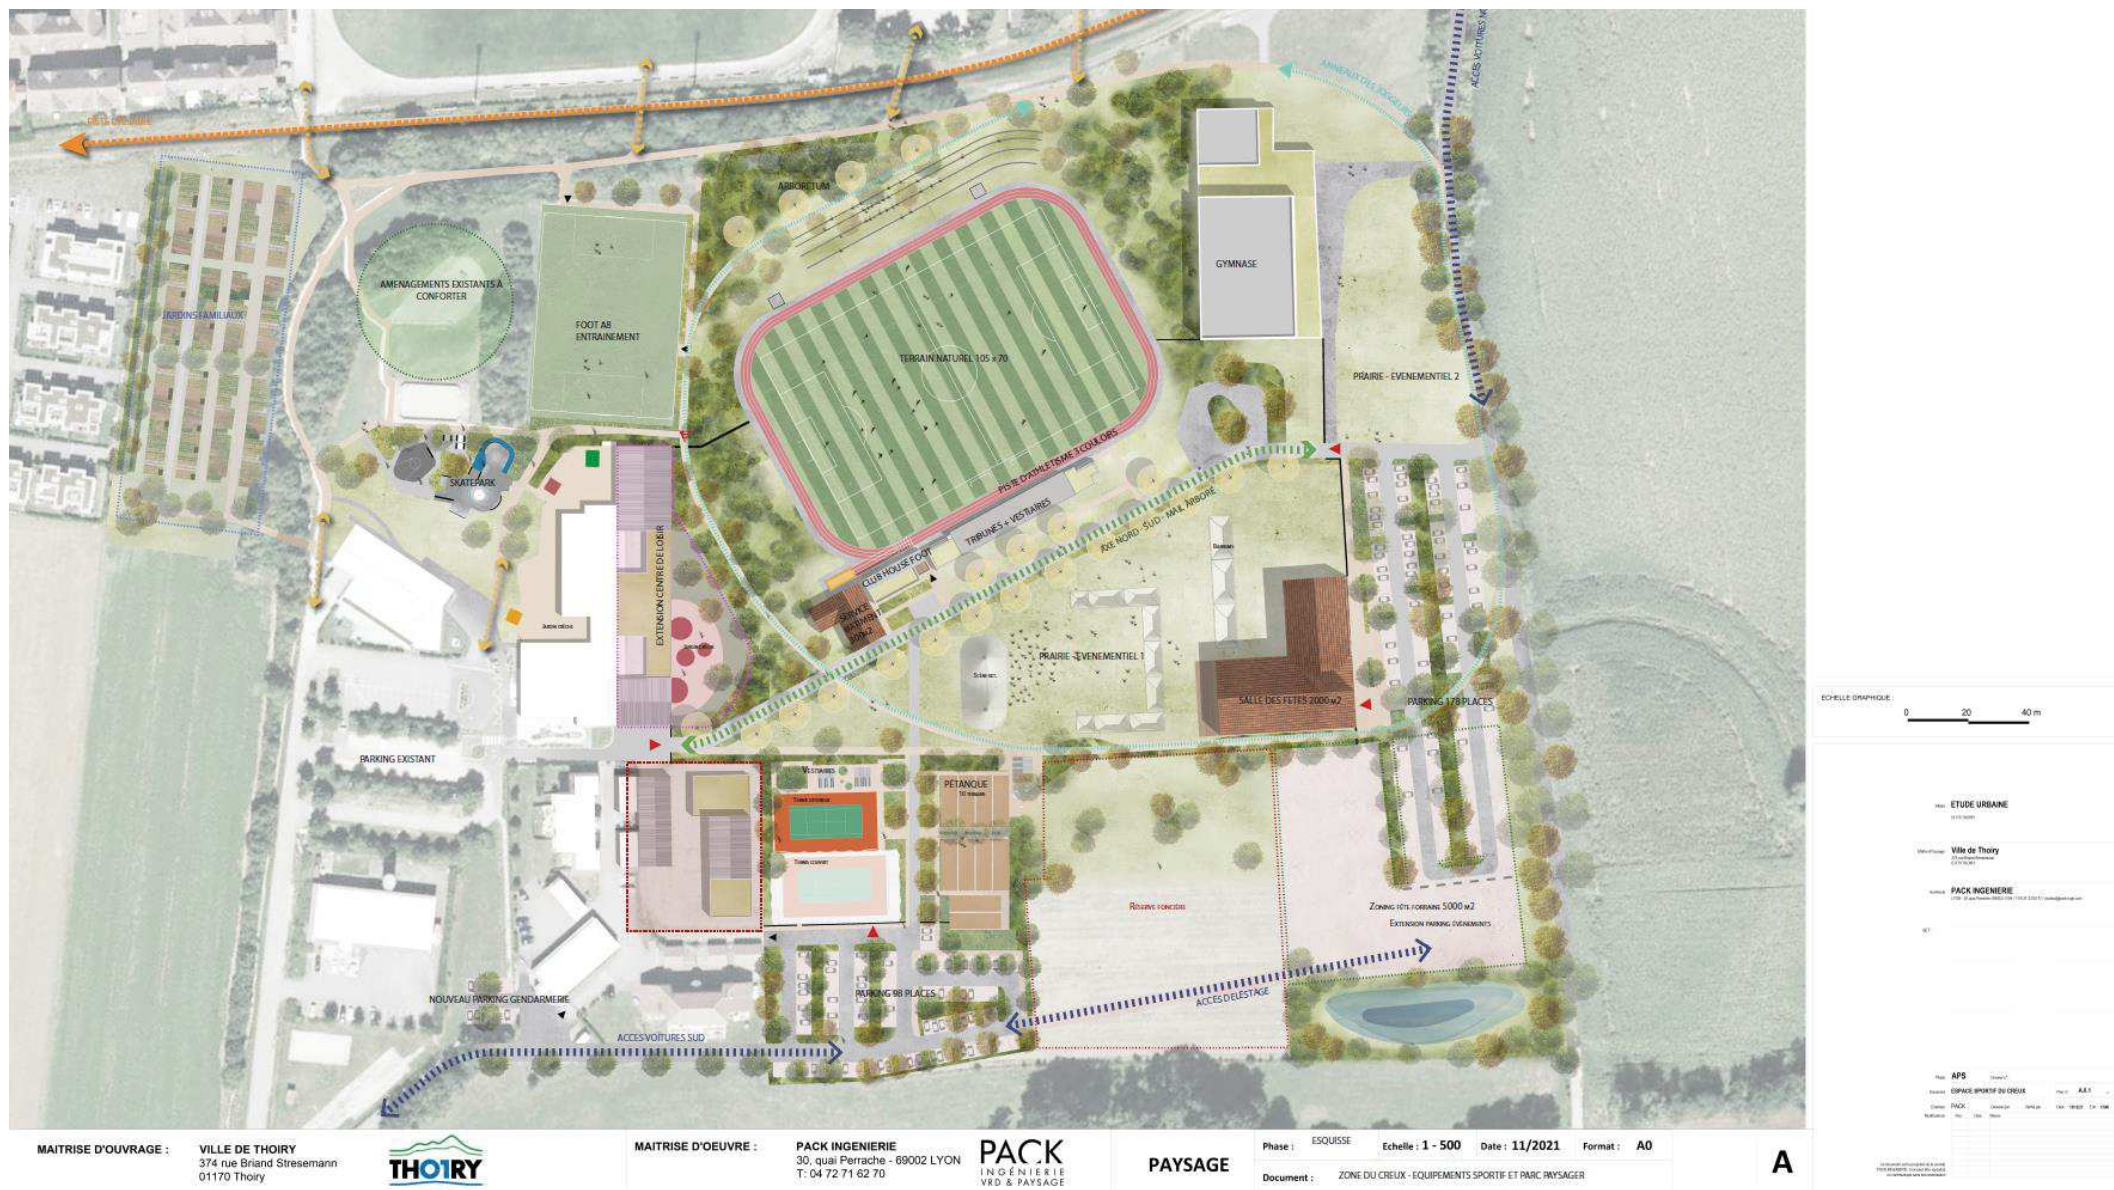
Plan de la zone d'étude (Source : Pack Ingénierie 2022)
